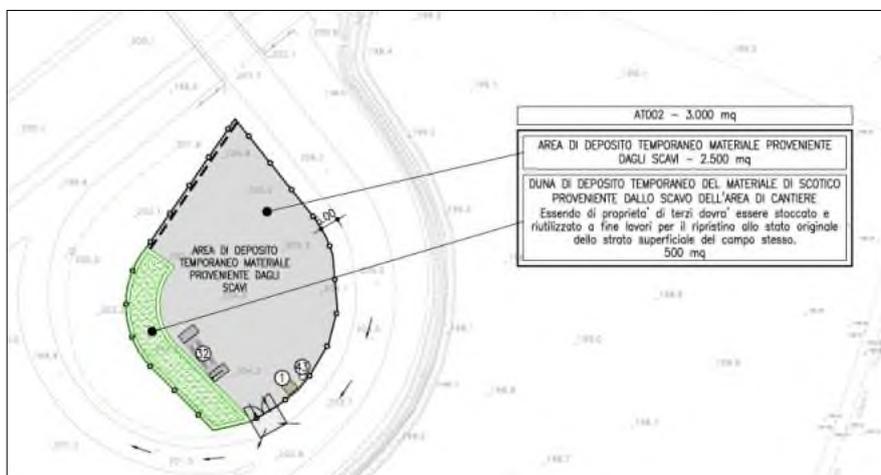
Disposizione dell'area AT002, deposito intermedio degli scavi (stralcio da CAP201)
